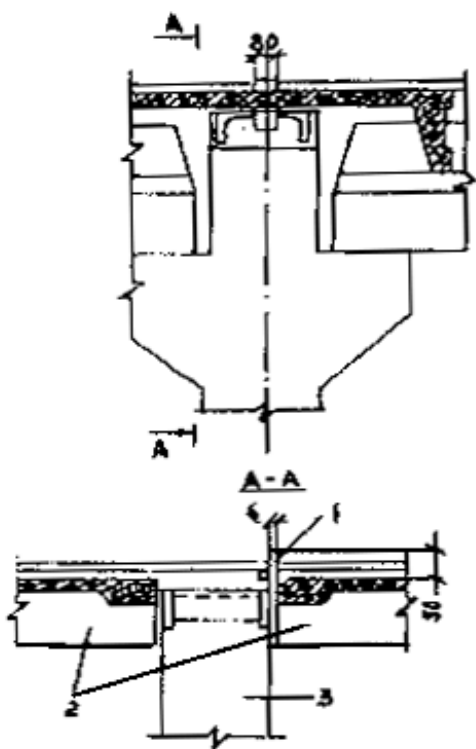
Узел в системе молниезащиты многоэтажного здания с железобетонными ригелями с полками:
